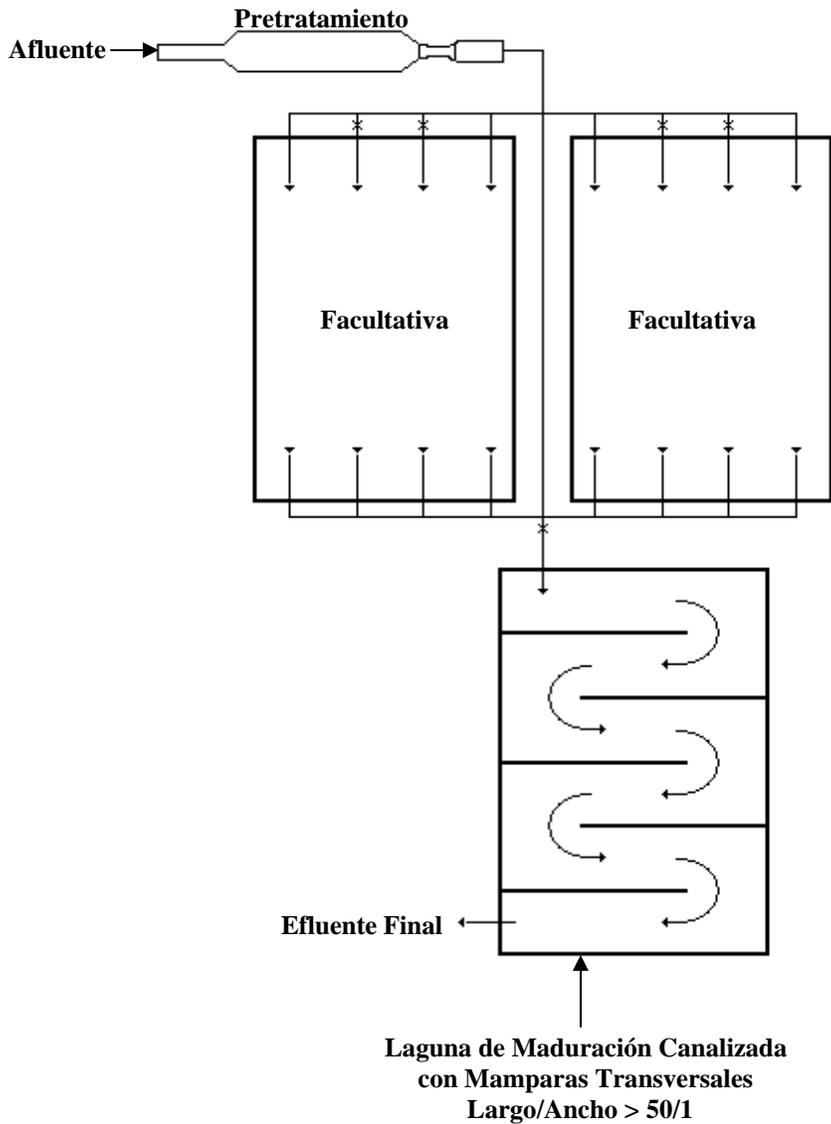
Una batería de dos lagunas facultativas en paralelo seguida por una laguna de maduración en serie. La laguna de maduración está canalizada con mamparas transversales con una relación largo/ancho de más de 50/1 para aproximar el flujo de tipo pistón sin efectos del viento. Este diseño es el más recomendado para las municipalidades.
